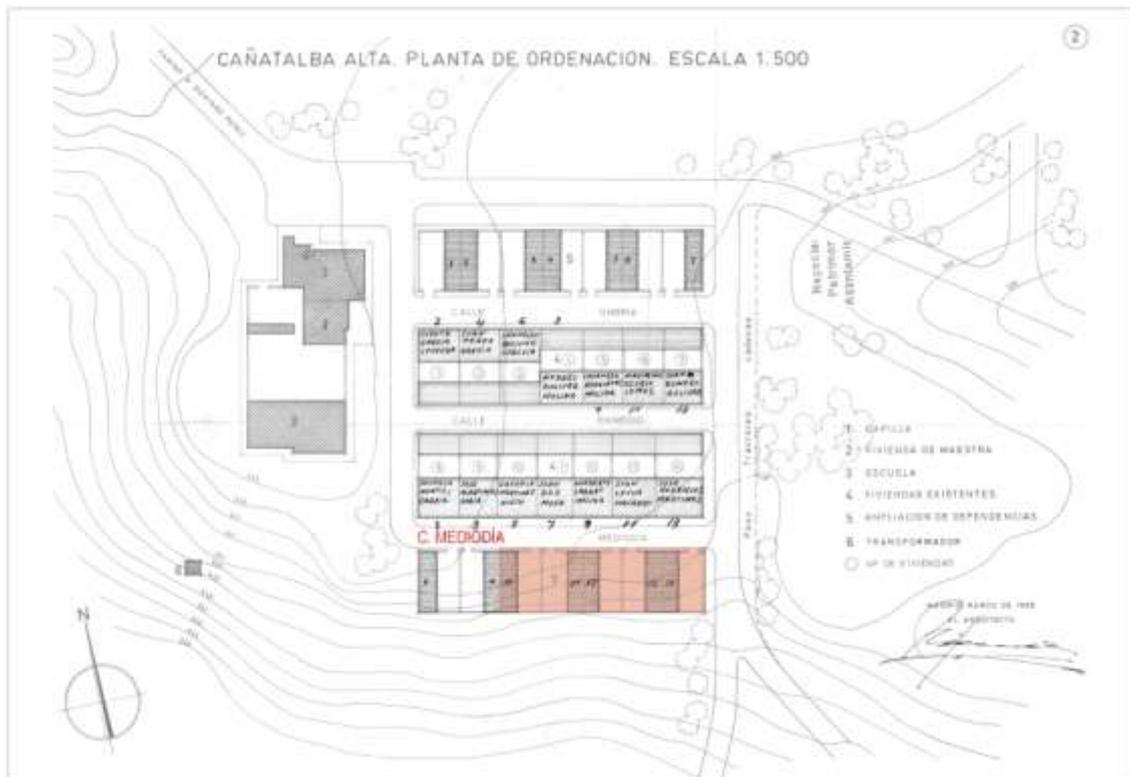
Plano del proyecto original de Cañatalba Alta. En rojo las viviendas incluidas en la Ilustración 10. Fuente: Archivo Colegio de Arquitectos de Granada.
